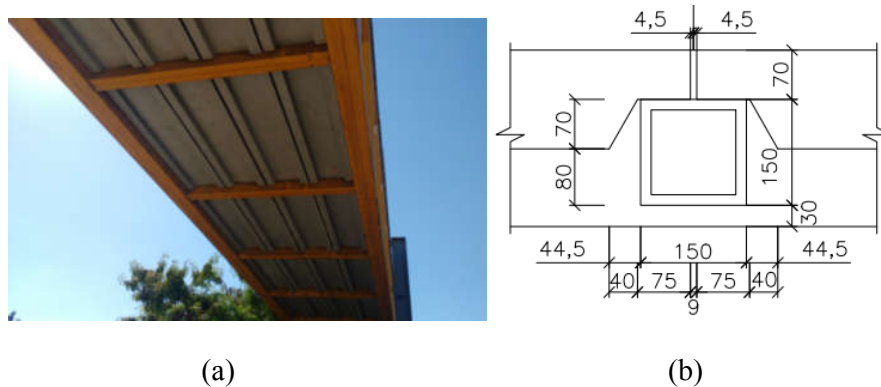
(a) Foto da laje com enrijecedores na parte inferior e (b) detalhe do apoio da laje nas vigas transversinas (dimensões em mm)
